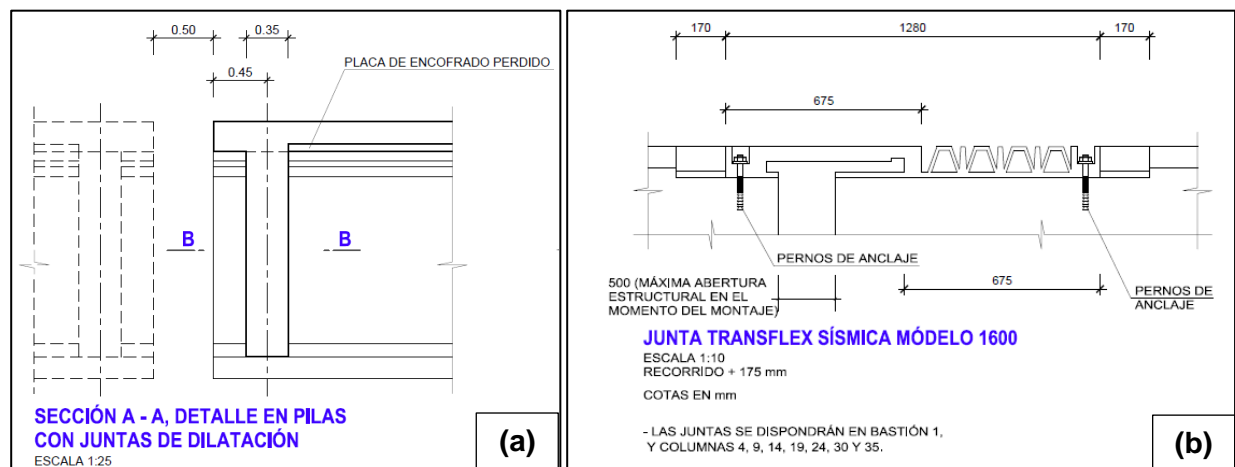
Detalles de la junta de dilatación o expansión indicados en los planos del proyecto. (a) Detalle de la separación entre superestructuras contiguas. (b) Detalle del montaje de la junta Transflex.
